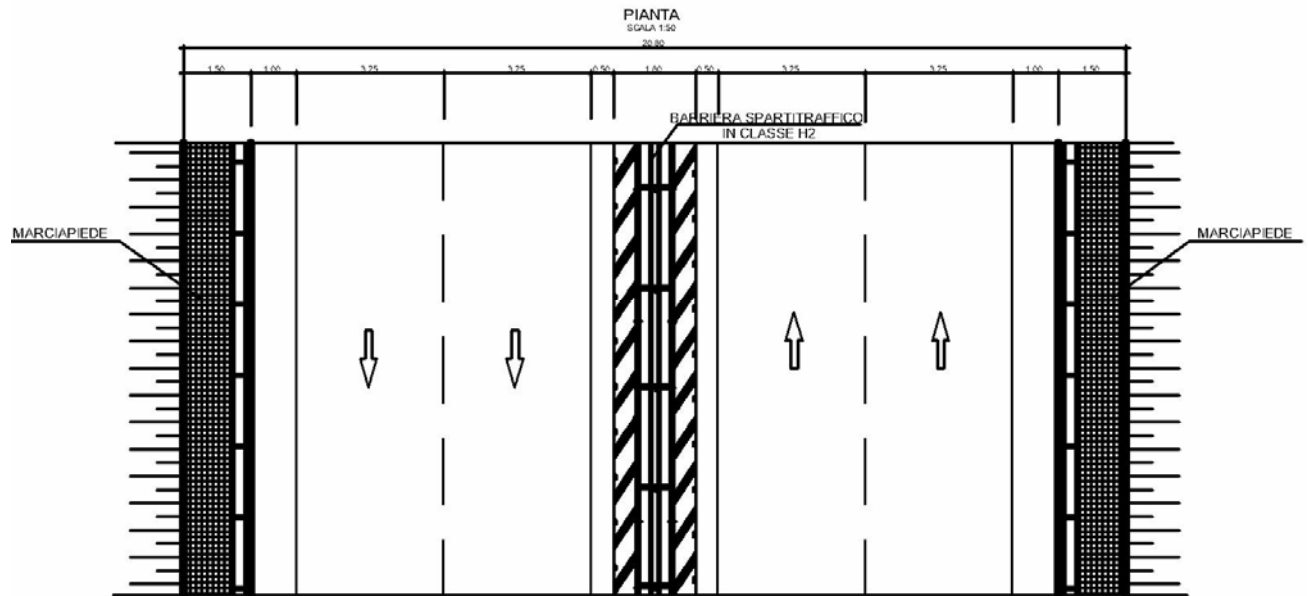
La piattaforma stradale in progetto (asse principale)
